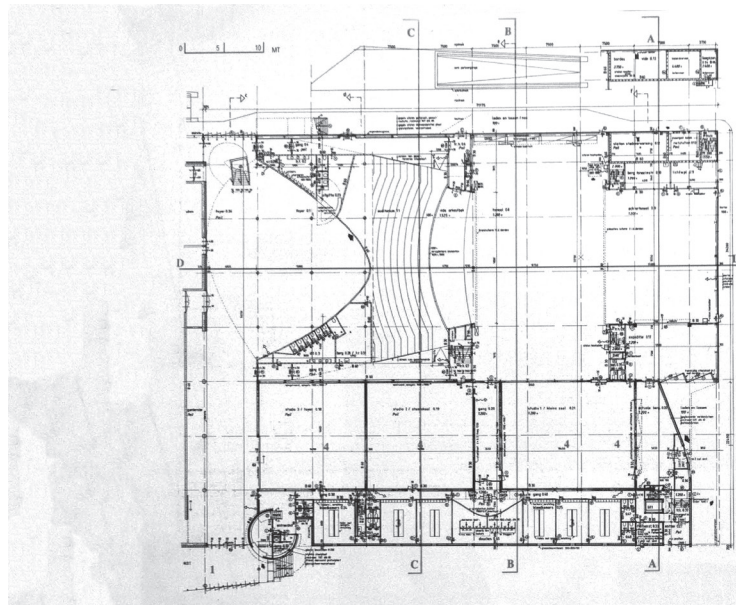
O Teatro da Dança, OMA, 1981. Planta 1º pavimento, versão final.
